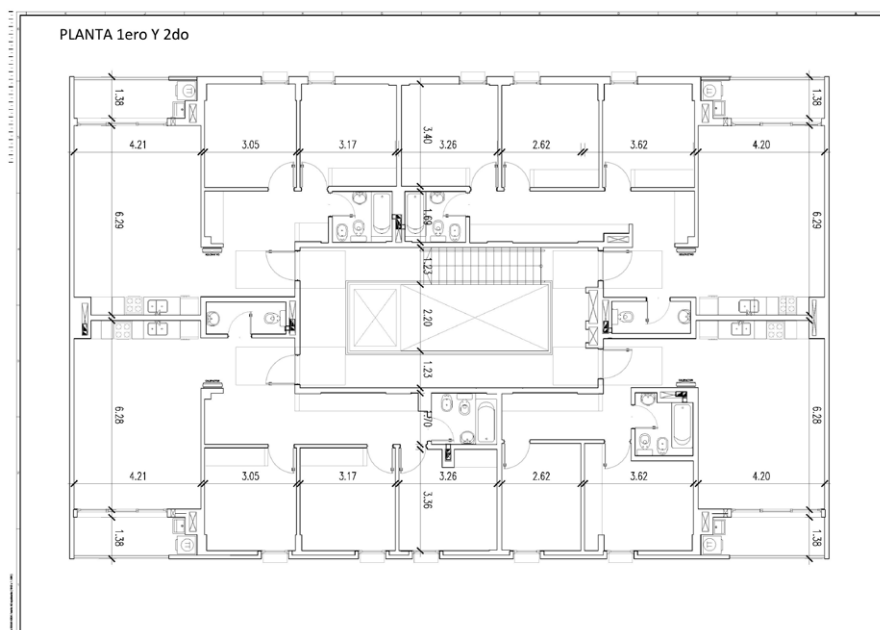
Detalle de sector de las tiras bajas. Las tiras son dobles y las viviendas ventilan a cada lado.
